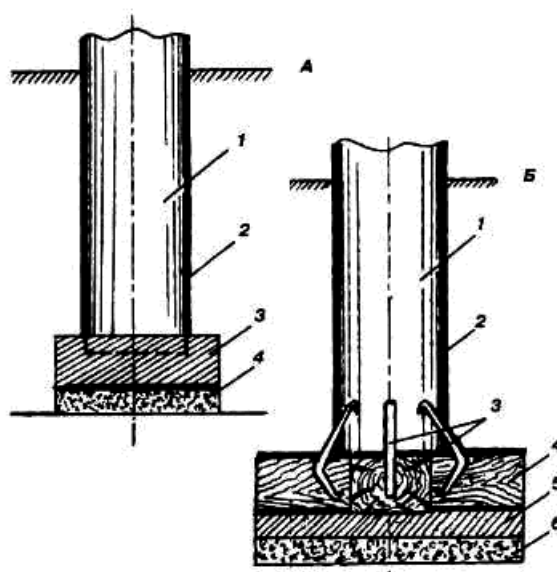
Деревянный столбчатый фундамент. Вариант А: 1 - столб из бревна; 2 - гидроизоляция; 3 - бетонная опора; 4 - песчаная подушка. Вариант Б: 1 - столб из бревна; 2 - гидроизоляция; 3 - скоба; 4 - деревянная крестовина; 5 - бетонная опора; 6 - песчаная подушка.
